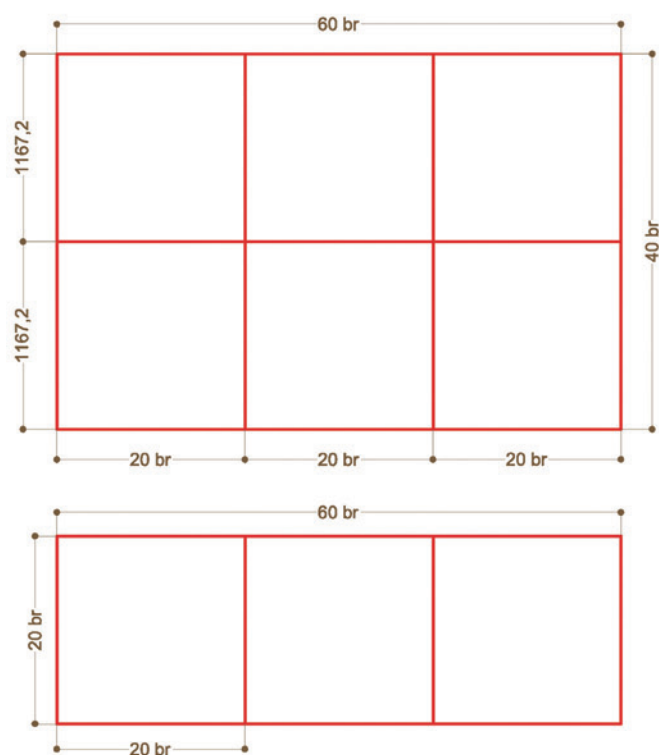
Schéma 1 du plan et de la façade de la Loggia
